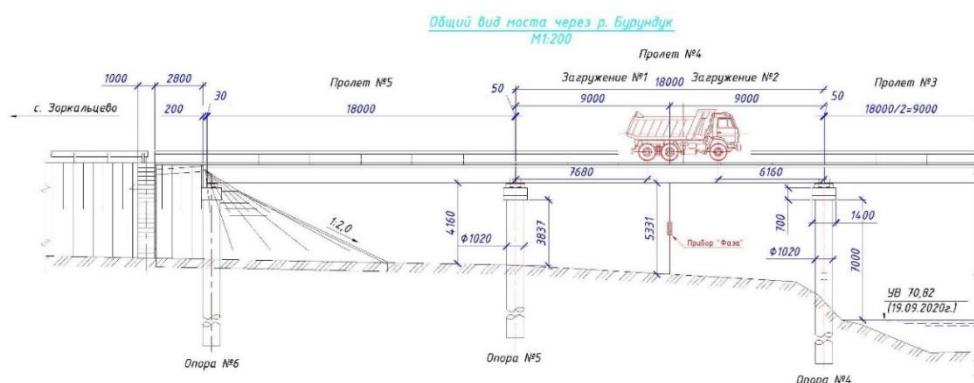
Фасад моста со схемой расположения испытательной нагрузки и прибора «ФАЗА-1Т». Схема выполнена А.А. Банниковым
